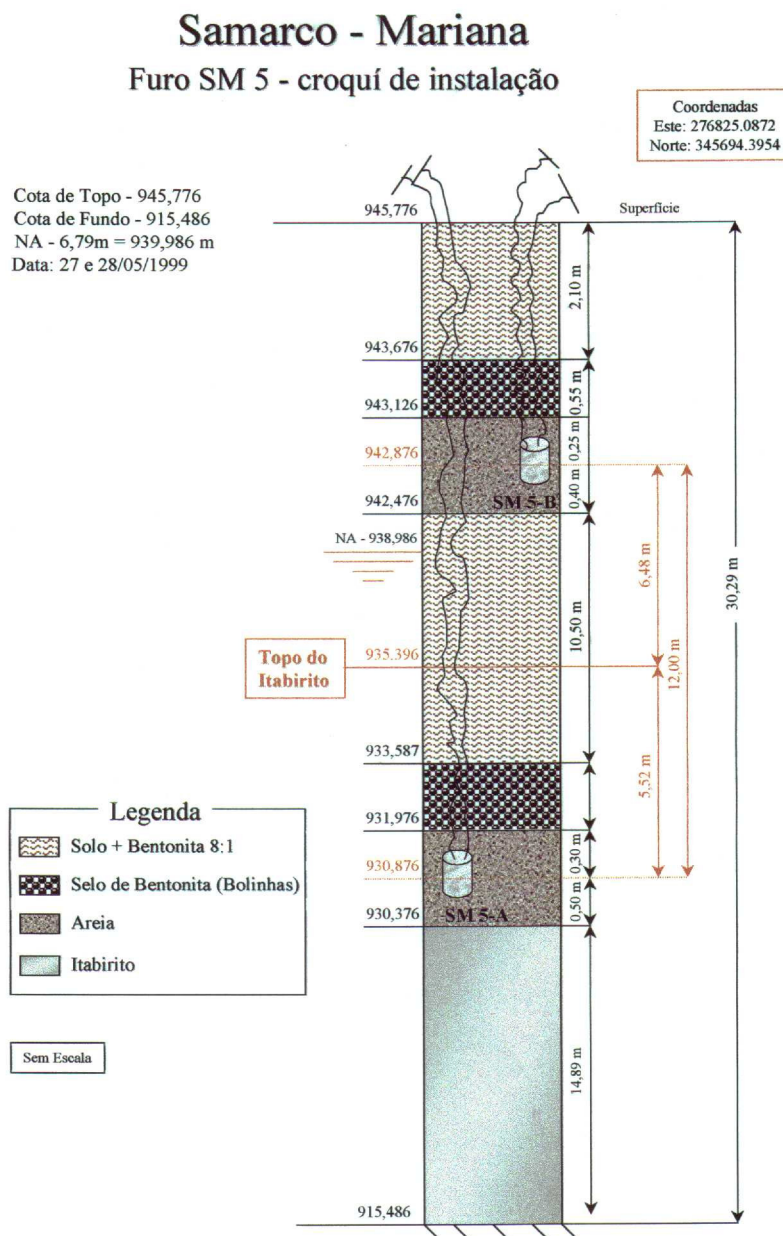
Detalhe da instalação do piezômetro pneumático próximo ao furo SM-05.
